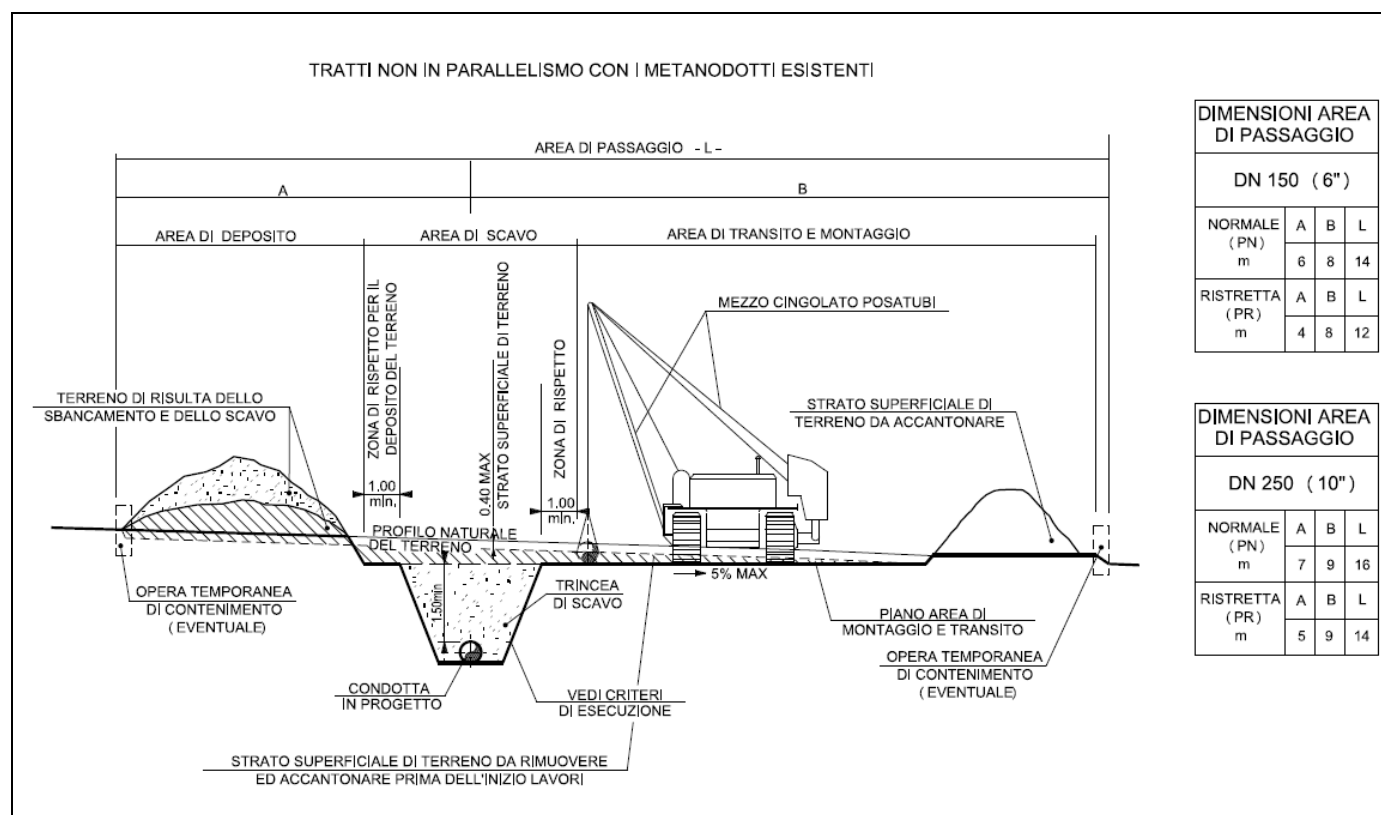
Sezione tipica dell'area di passaggio per posa condotta
